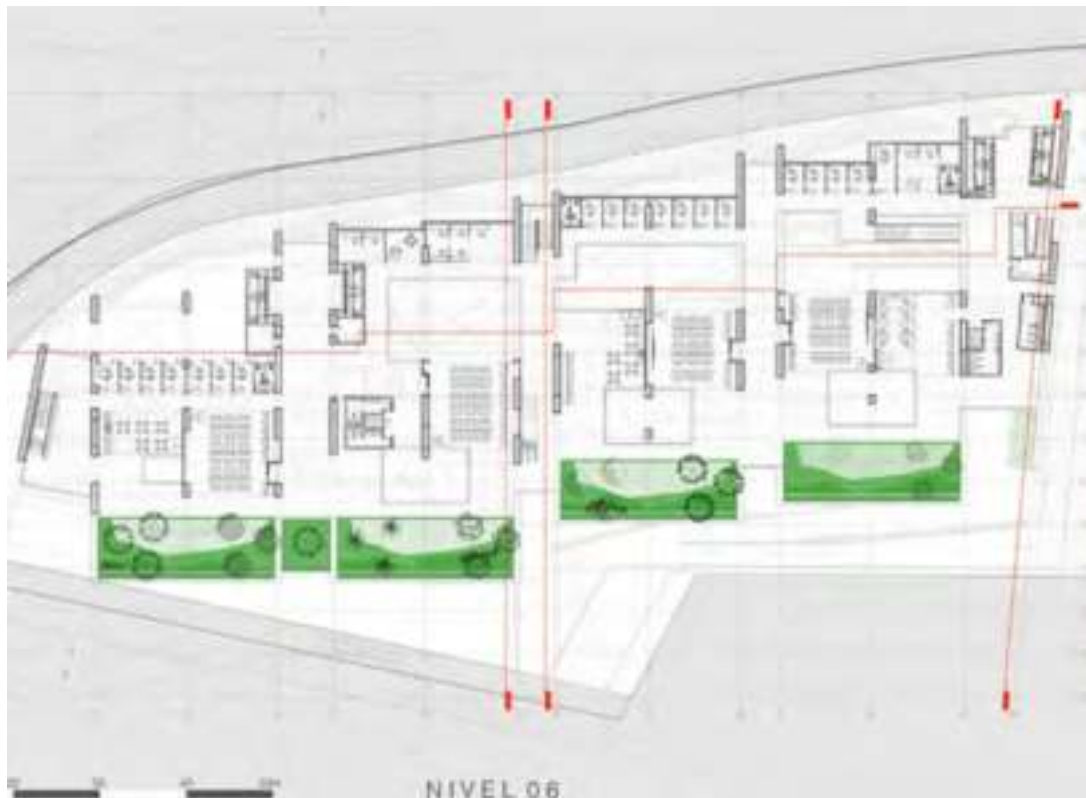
Campus UTEC- Plano 6 Nivel. Fuente:
